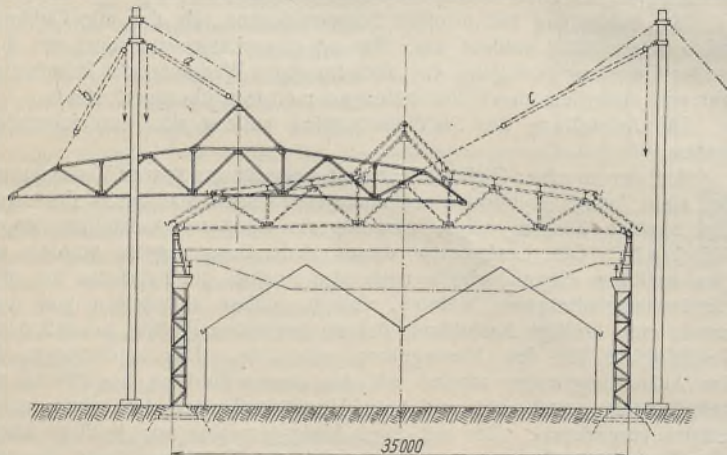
Umbau der Walzwerkshalle eines westfälischen Stahlwerkes. (Binderlage beim seitlichen Vorholen.)
